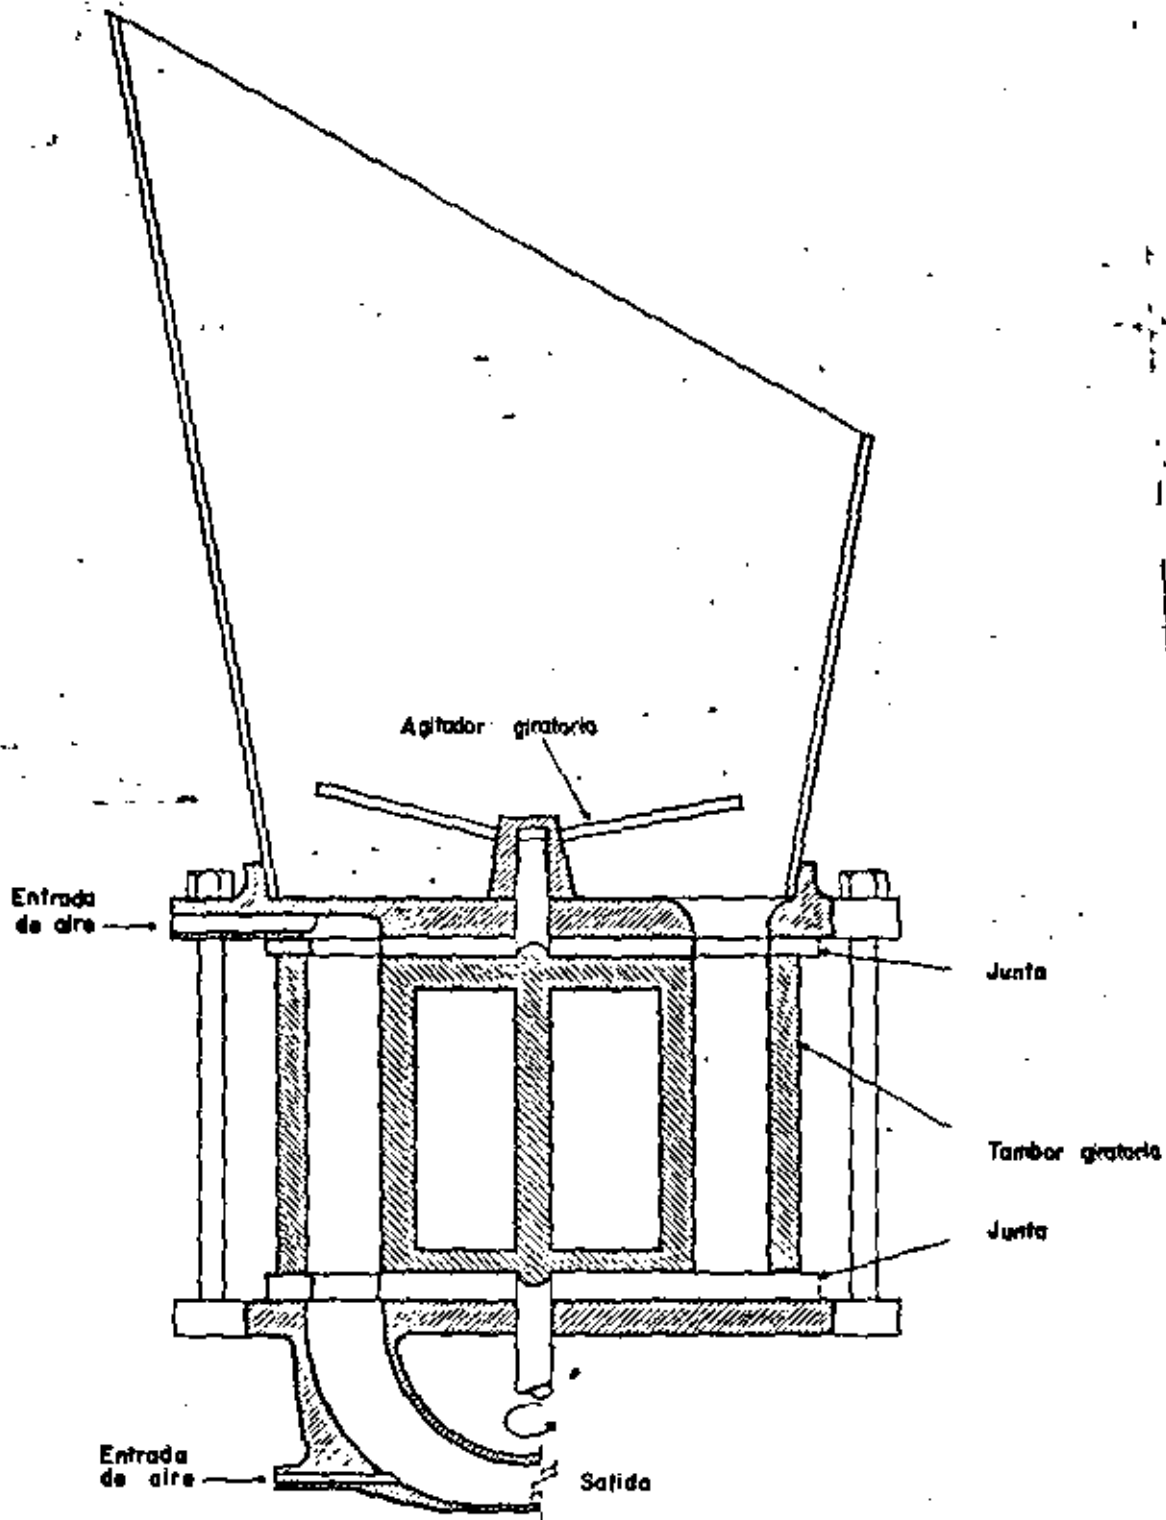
MAQUINA LANZADORA DE TAMBOR ROTATORIO
